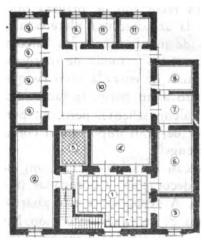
Salta — Pianta baja de la casa "de Arias".
